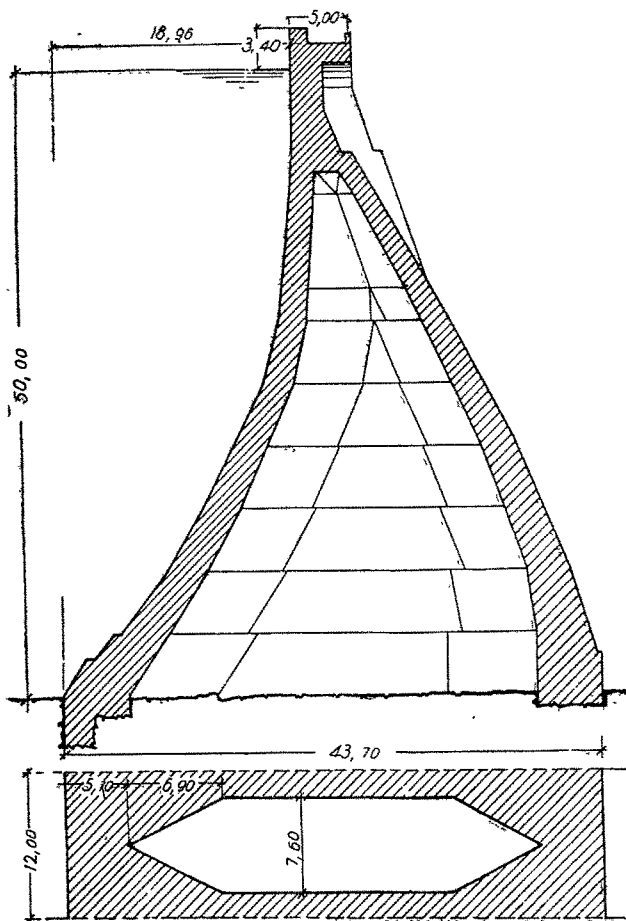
Profil et plan du barrage à évidements intérieurs sur le torrent de Rochemolles (projet)
